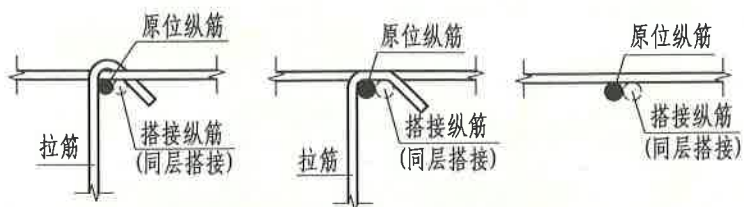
剪力墙分布钢筋处的钢筋搭接位置
